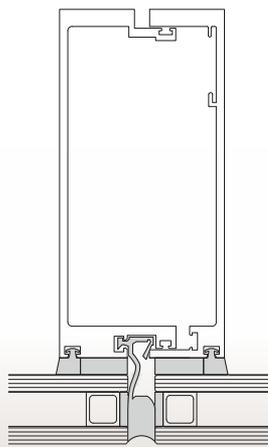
Muro cortina con silicona estructural y junta climática seca burleteada.
